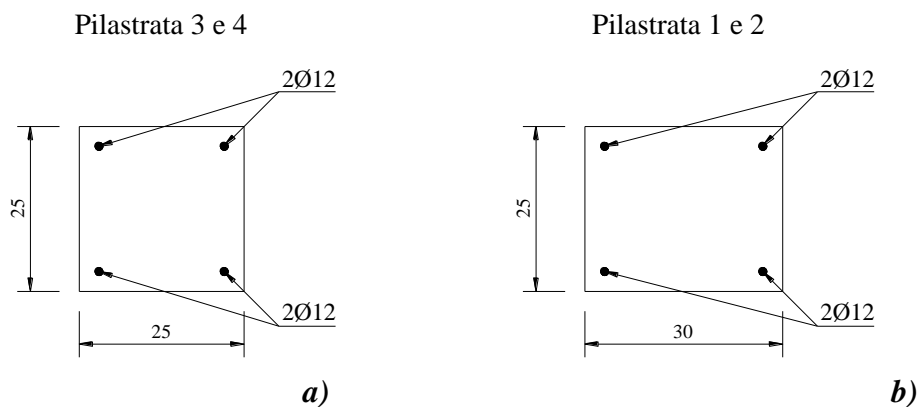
Sezioni dei pilastri: *a)* pilastrata 3 e 4, *b)* pilastrata 1 e 2.
